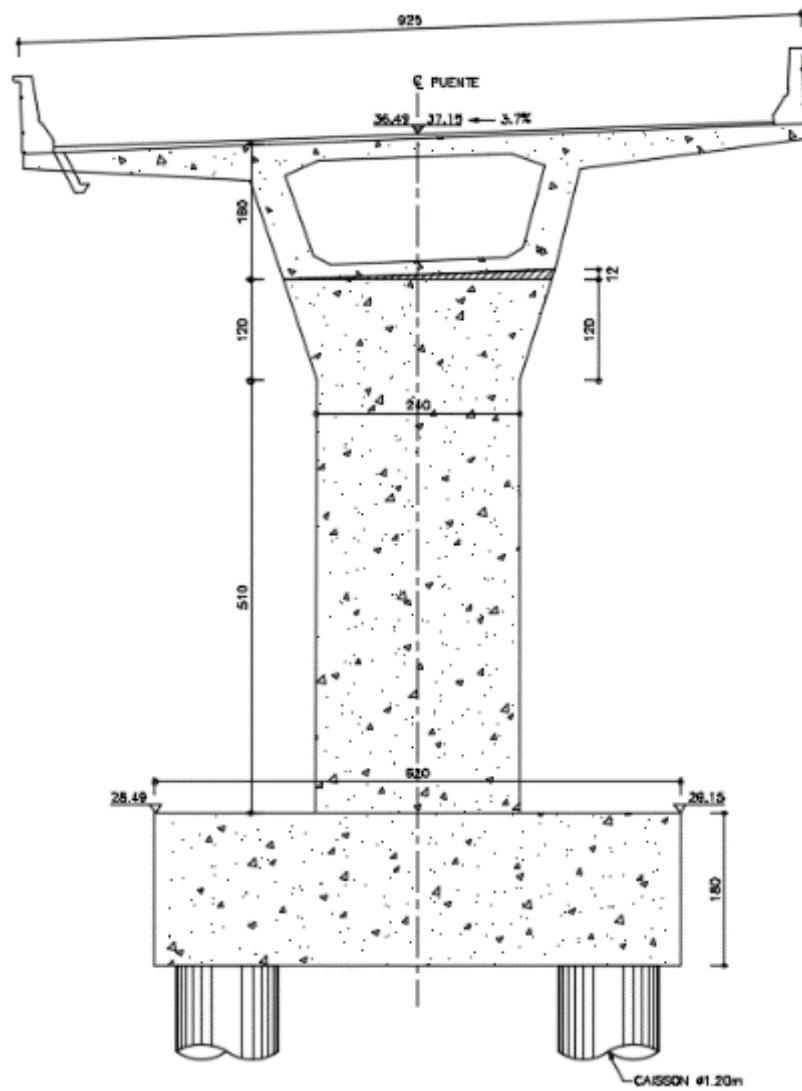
Geometría apoyos ejes 2 y 4 – Puente Vía a Minca
